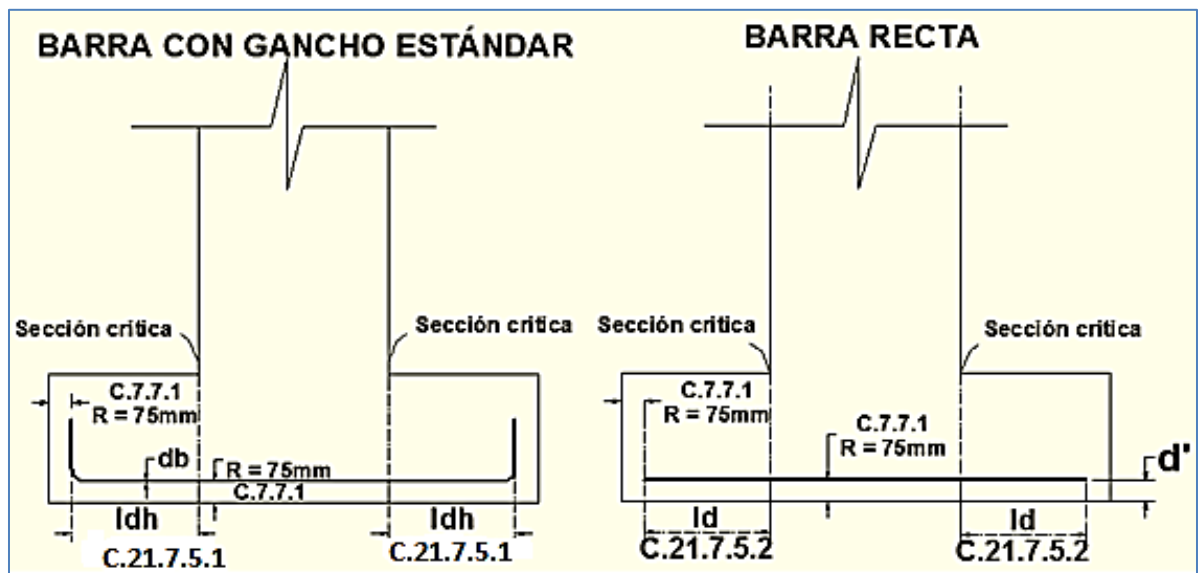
Longitud de Desarrollo a Tracción en Zapatas Aisladas.
